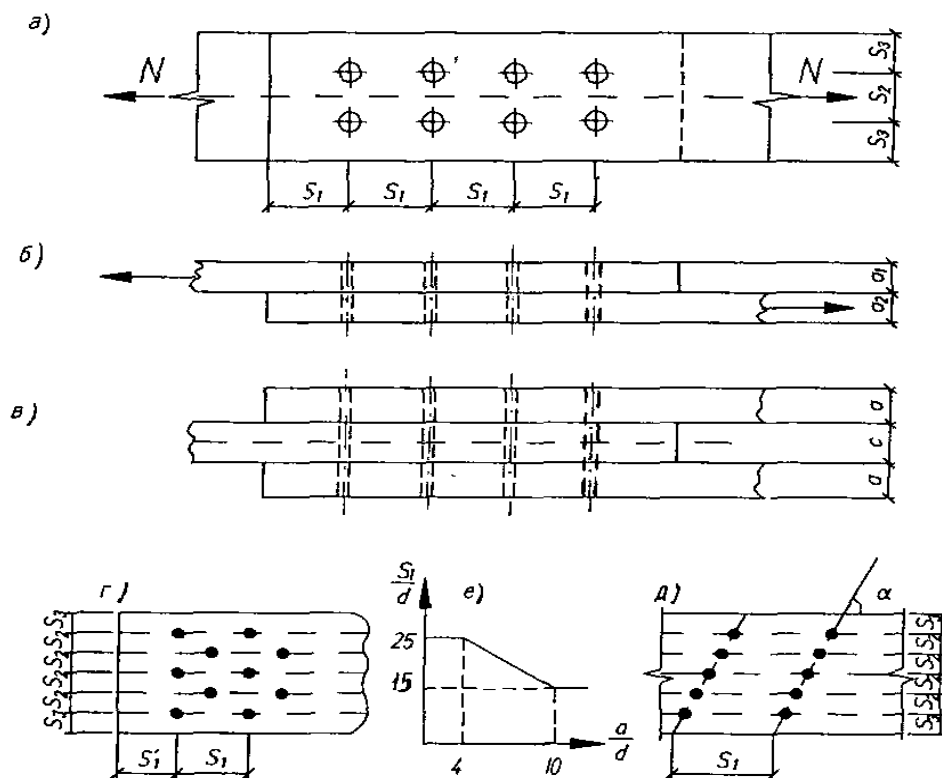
Загальний вид з'єднання на циліндричних нагелях
